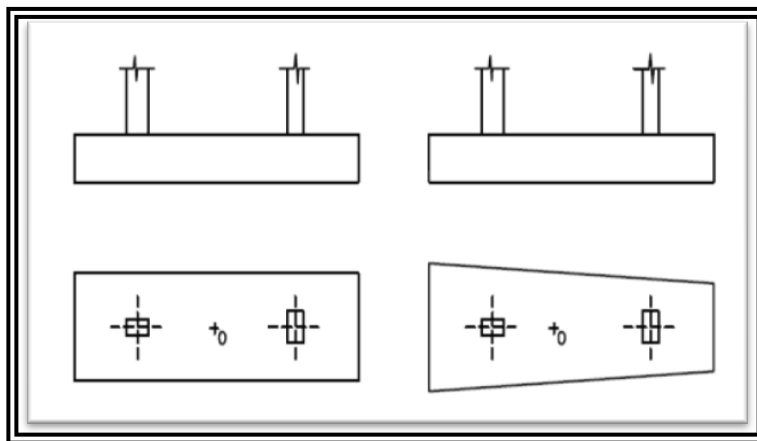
83 Zapata combinada en vista de perfil longitudinal y en planta¹⁰⁵.
